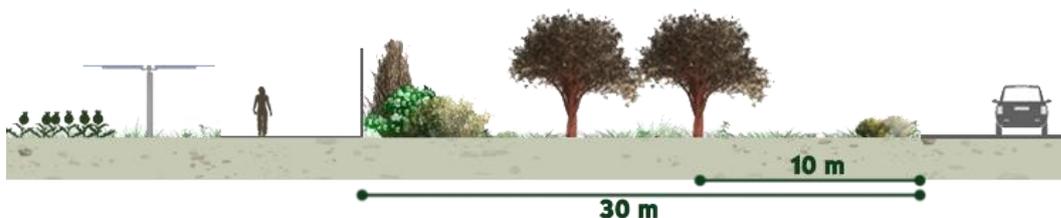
Distribuzione in sezione dell'oliveto e della siepe sul lato sud (S.P. 95)
